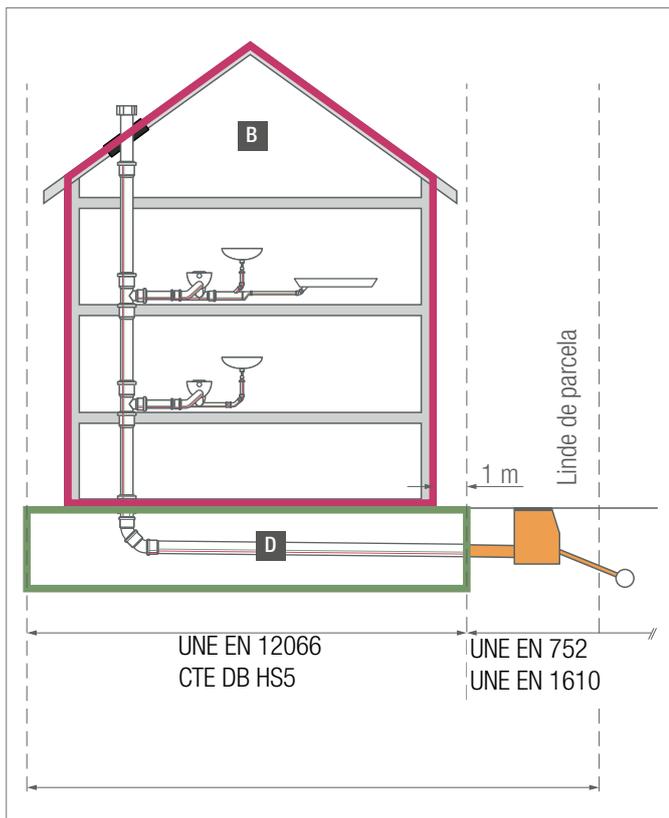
Instalación de RAUPIANO PLUS dentro y debajo de la estructura del edificio
